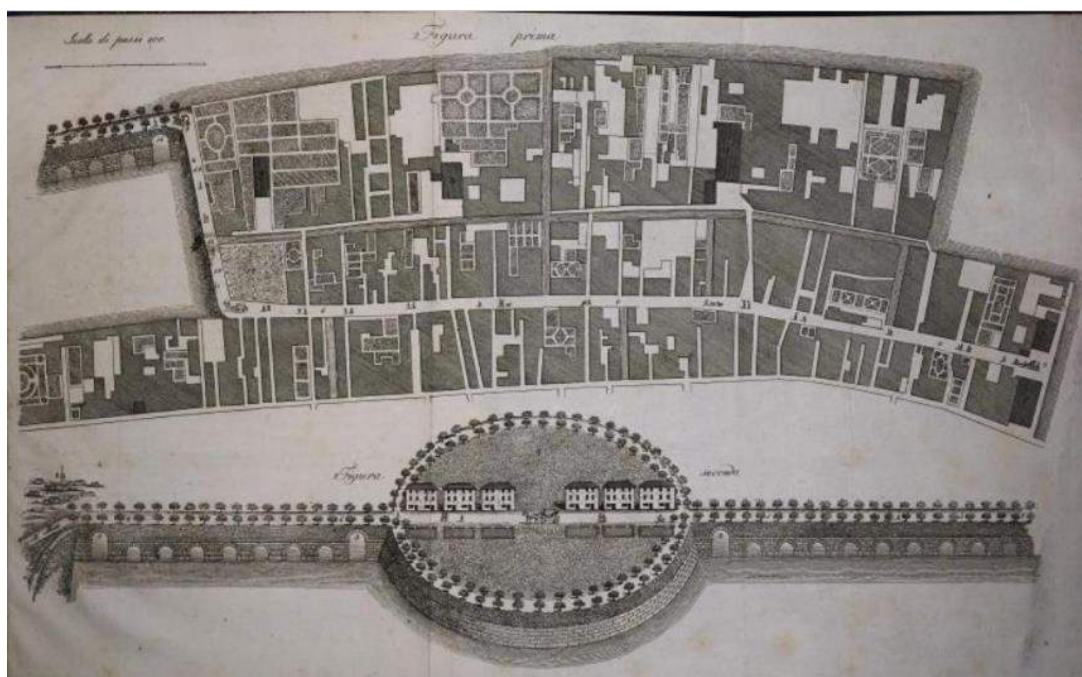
G. Picotti, Pianta e veduta del ponte di collegamento tra Venezia e la
